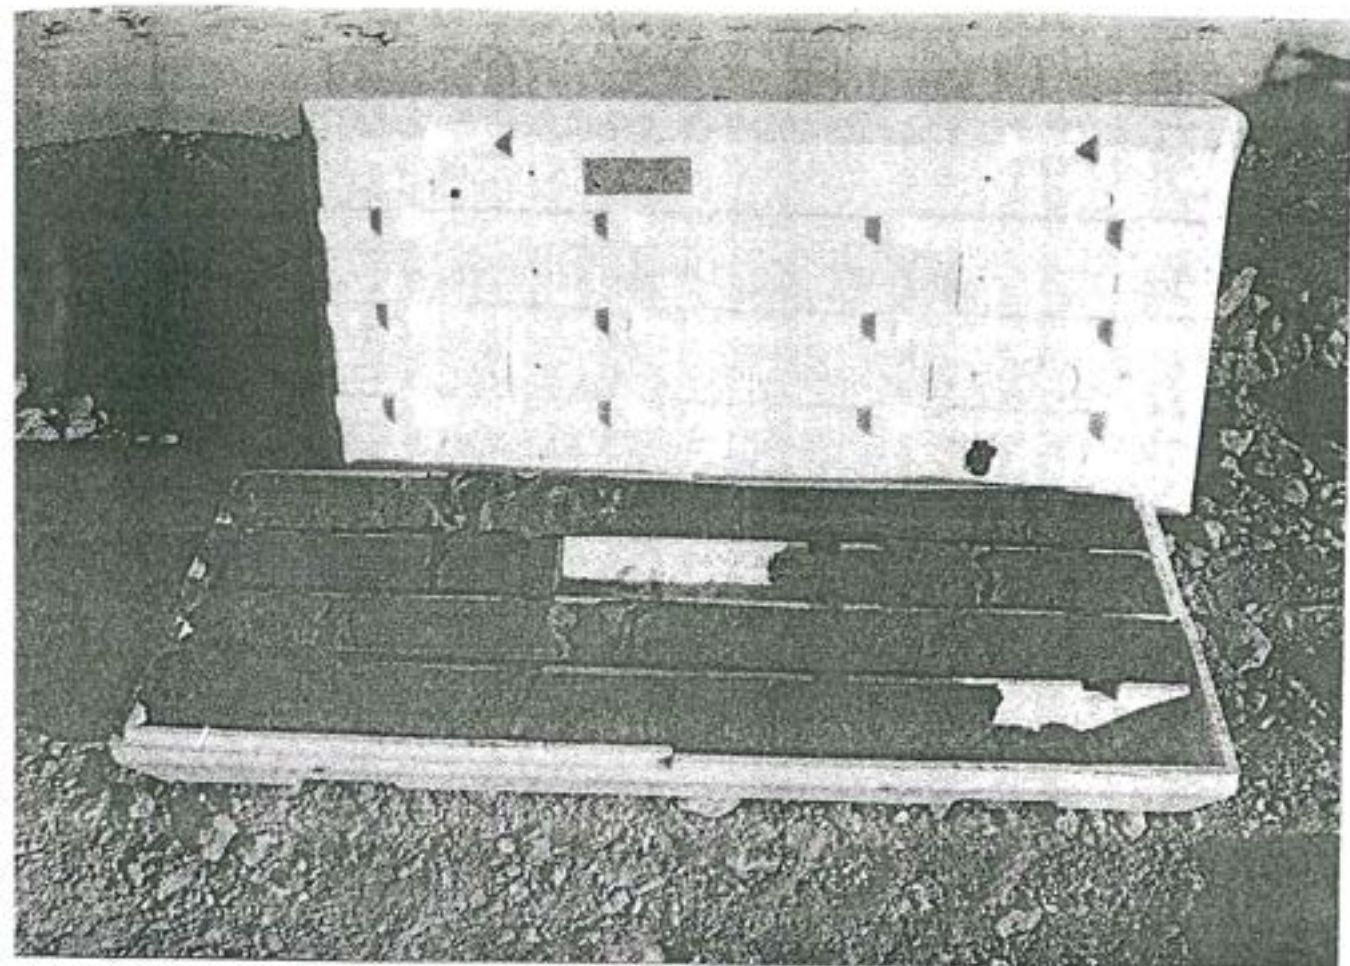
Cassetta 1 del sondaggio 2: da 0 a -5 metri
